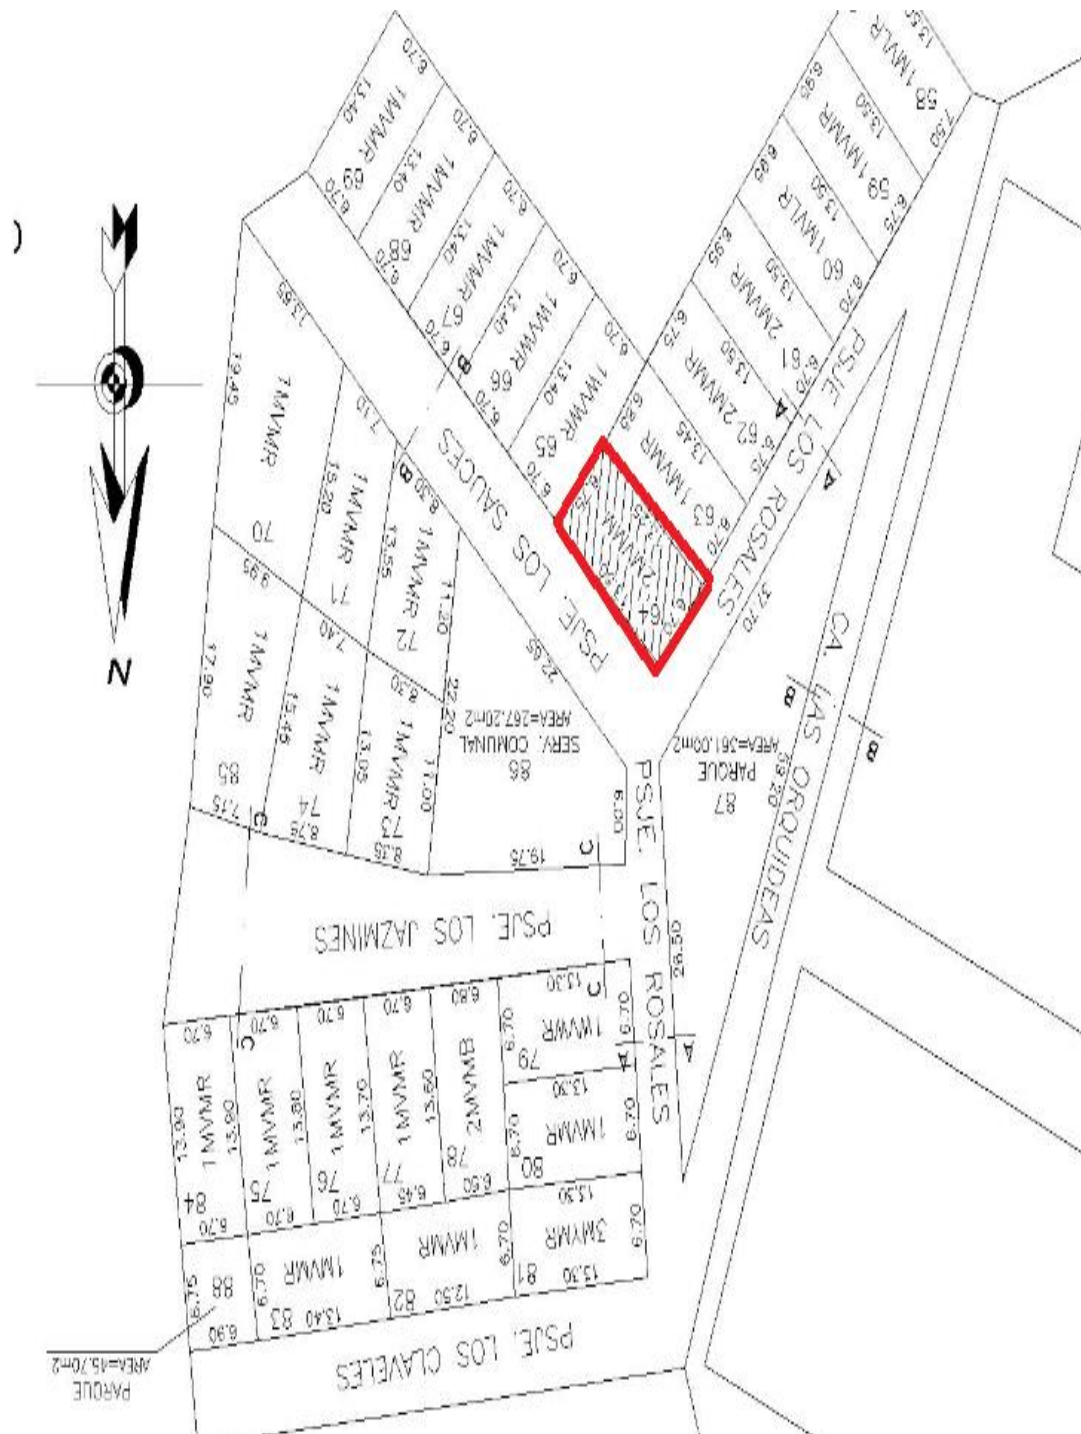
Ubicación del lote 64 en el plano de la UCV 120 Zona G (Fuente: Elaboración propia)
